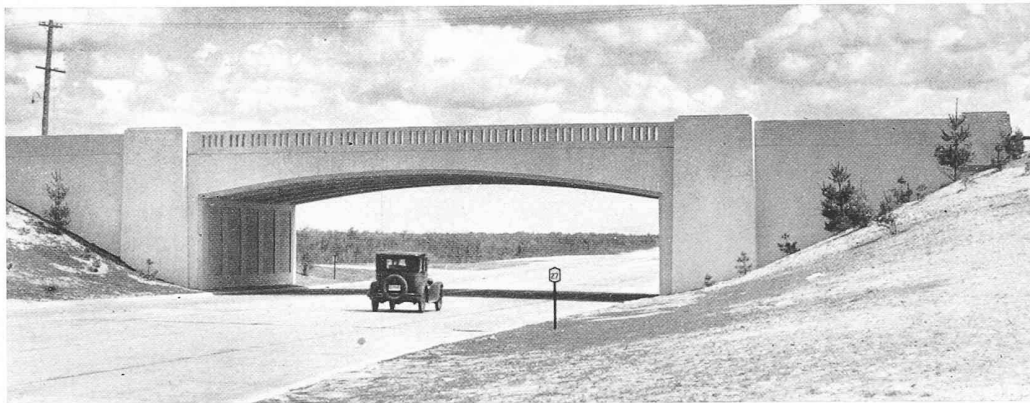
Segmentförmiger Eisenbetonrahmen mit Steinverkleidung
